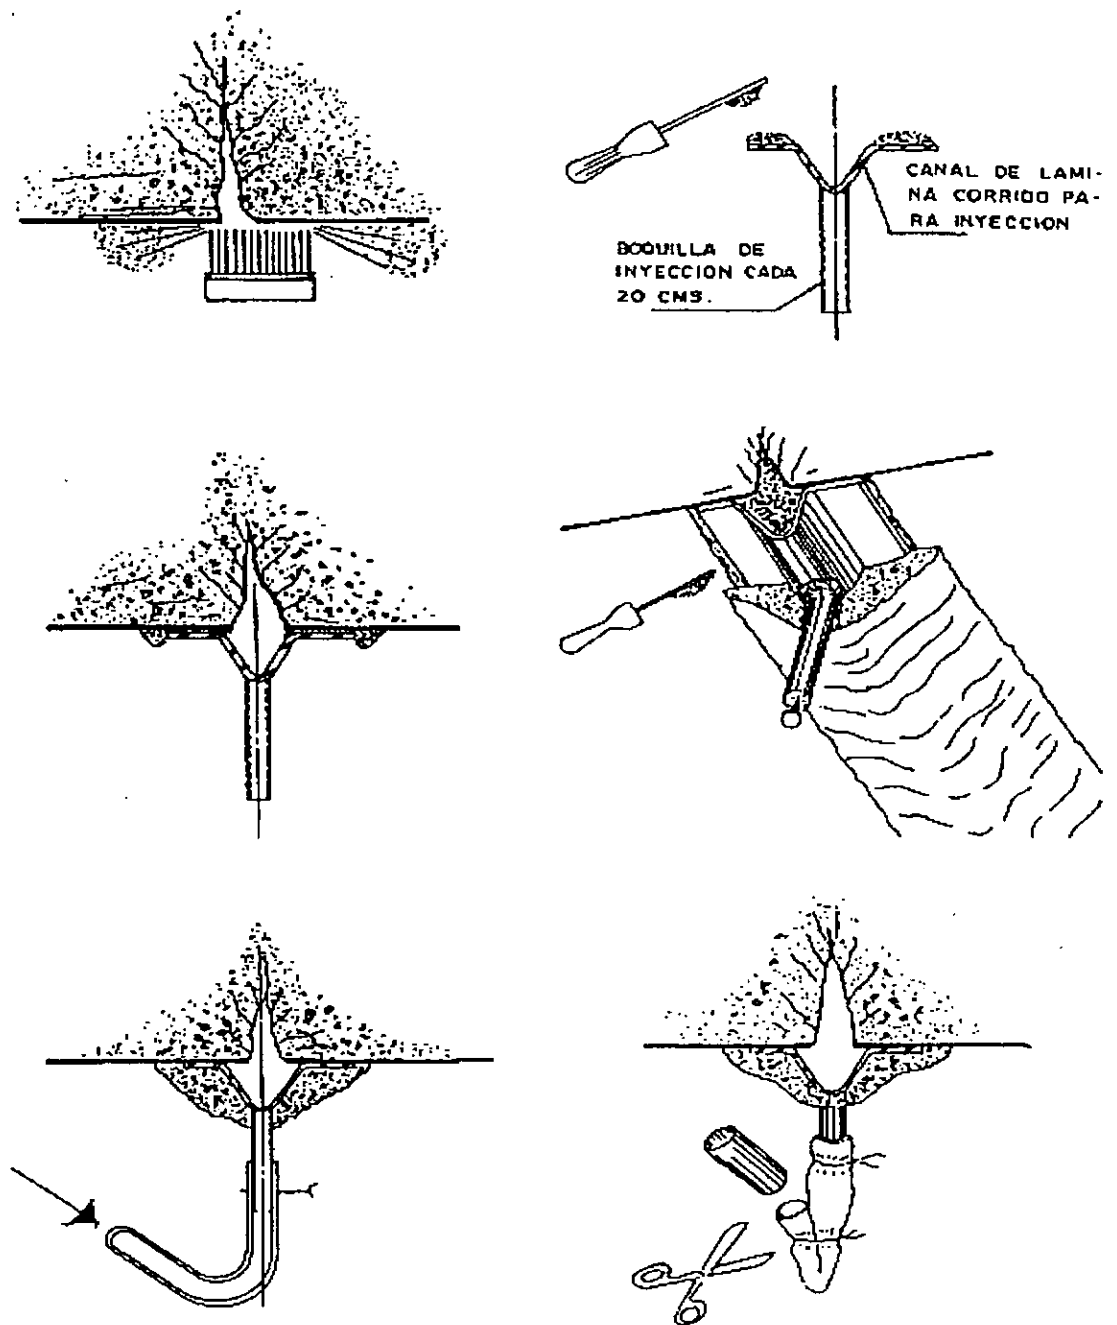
Inyección de fisuras con resinas epóxicas
